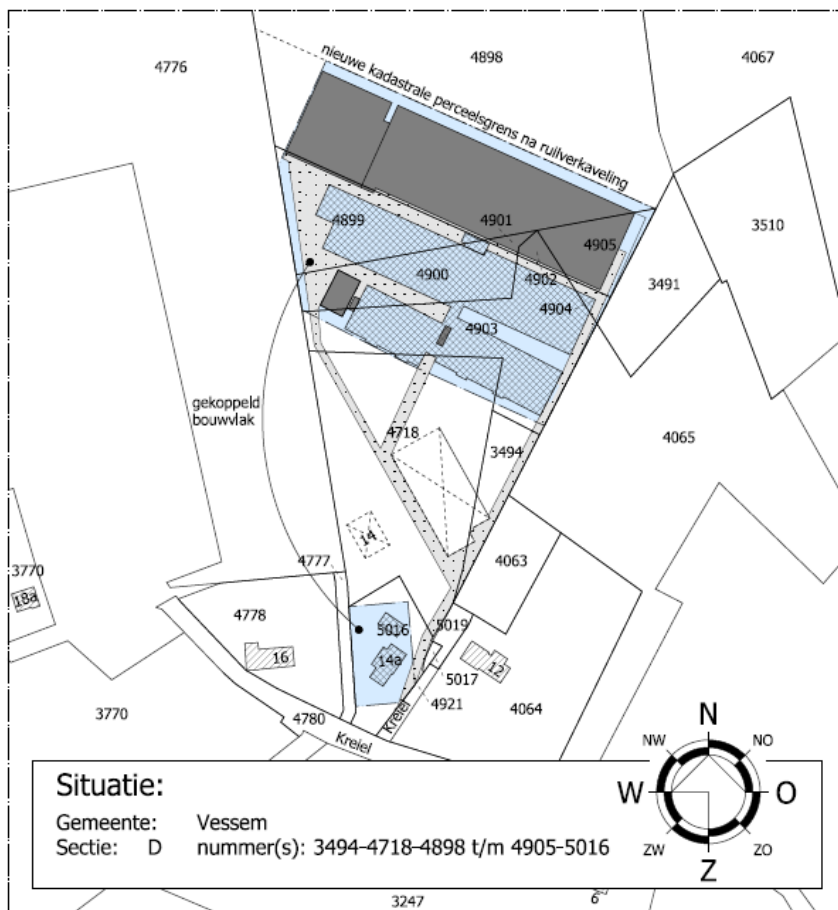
Ligging plangebied, Kreiel 14 en 14a Wintelre rood omkaderd weergegeven
